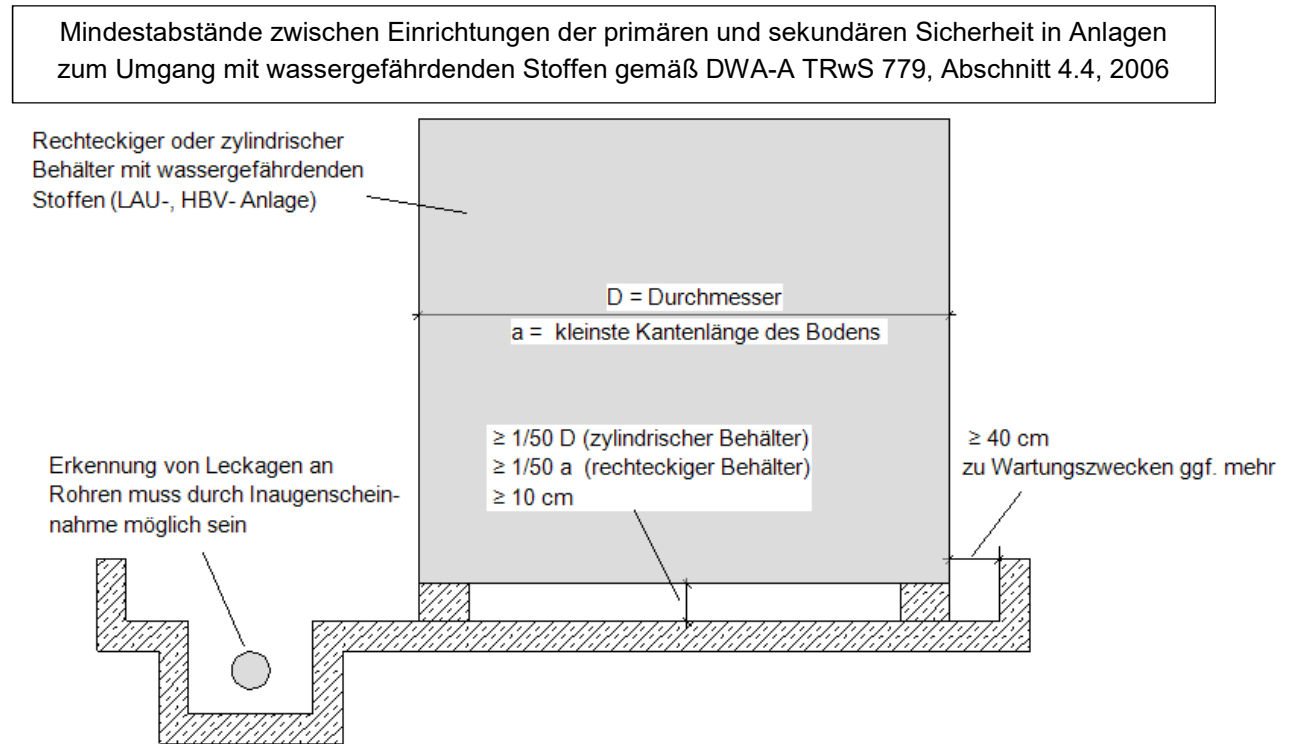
Sicherheitsabstände gemäß [DWA-A TRwS 779, Abschnitt 4.4, 2006] (Erstellt mit mb Worksuite 2017 Vicado – Studentenversion)
